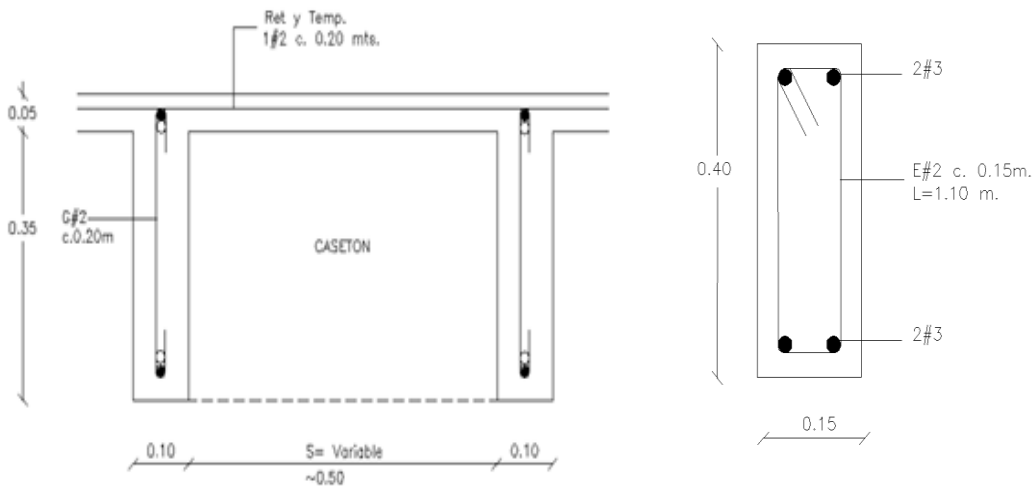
Sección en corte de losa Aligerada y Sección Riostra. (Fuente: GRACOL. SAS).
